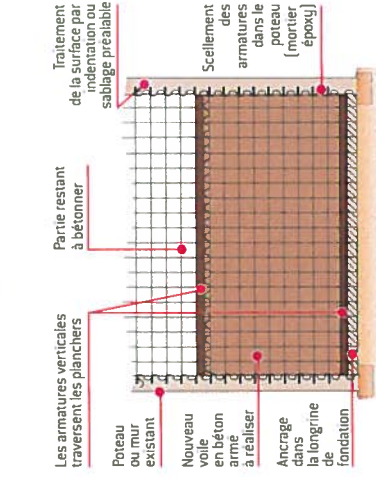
Exemple de renforcement du contreventement d'un bâtiment par création de murs nouveaux entre deux poteaux existants (élévation)
